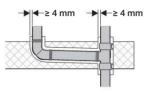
Pour les conduites de raccordement noyées dans la dalle en béton, des assemblages fixes sont nécessaires (manchons électro-soudables Geberit ou soudures au miroir). L'ensemble de la conduite est à découpler de la maçonnerie à l'aide du fourreau isolant Geberit Silent-db20, du bandage Silent-db20 ou du Geberit Isol sans plomb.
